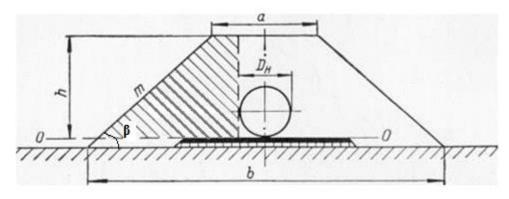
Параметры насыпи и трубопровода:  $D_{\rm H}$  — диаметр трубопровода равен 1020 мм; a — верхнее основание трапеции насыпи равное 1,7 м; h — высота трапеции равна 2,2 м; b — основание трапеции насыпи; m — заложение откосов
